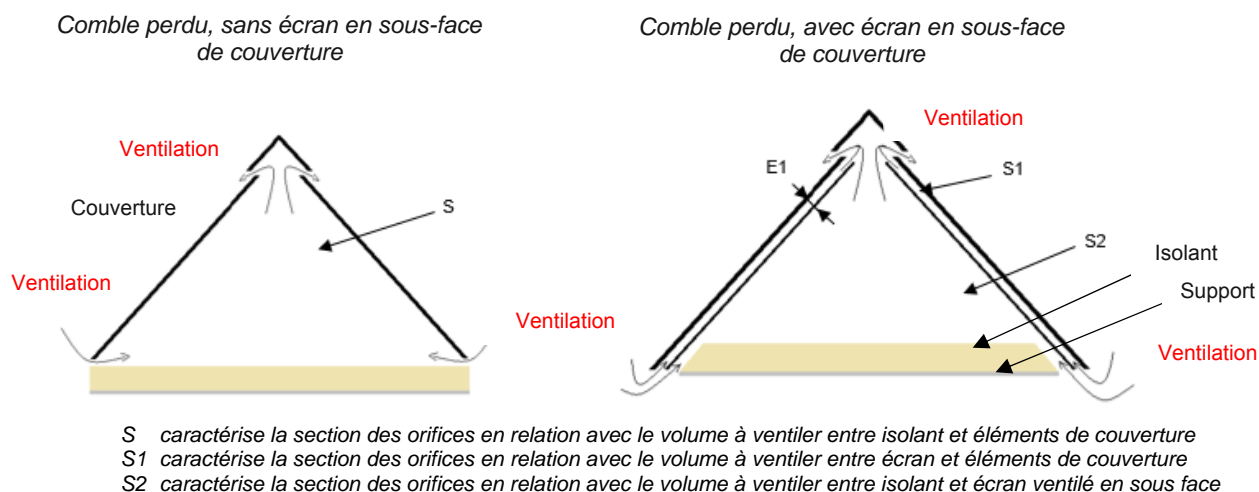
Ventilation du comble perdu – isolation sur plancher
